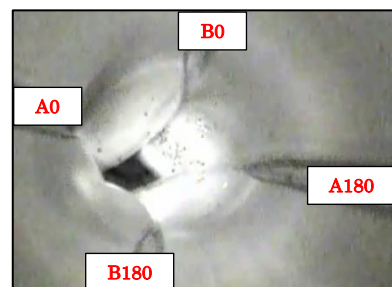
No.2孔ガイド管変形状況(GL-13m付近)
